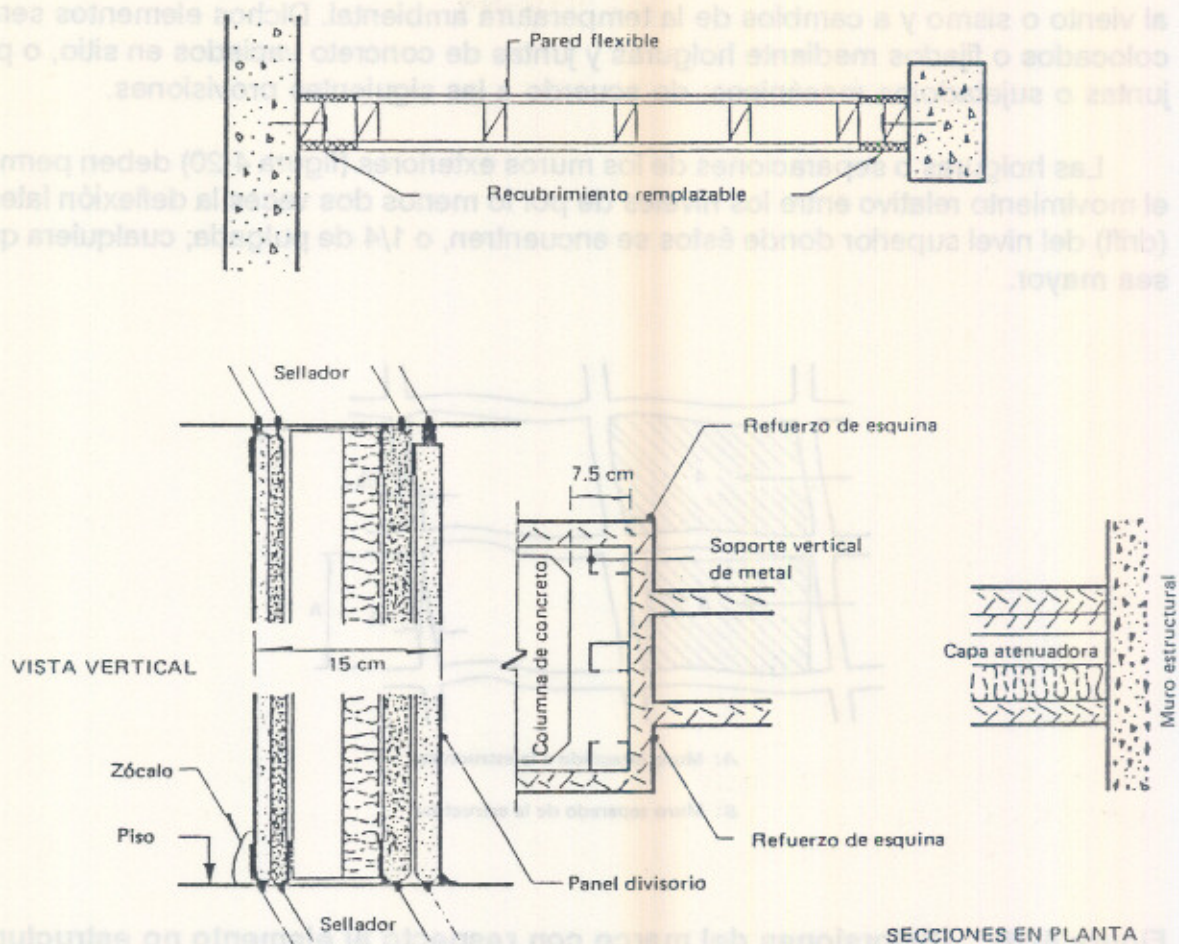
Detalles para desligar muros divisorios ligeros del sistema estructural.
